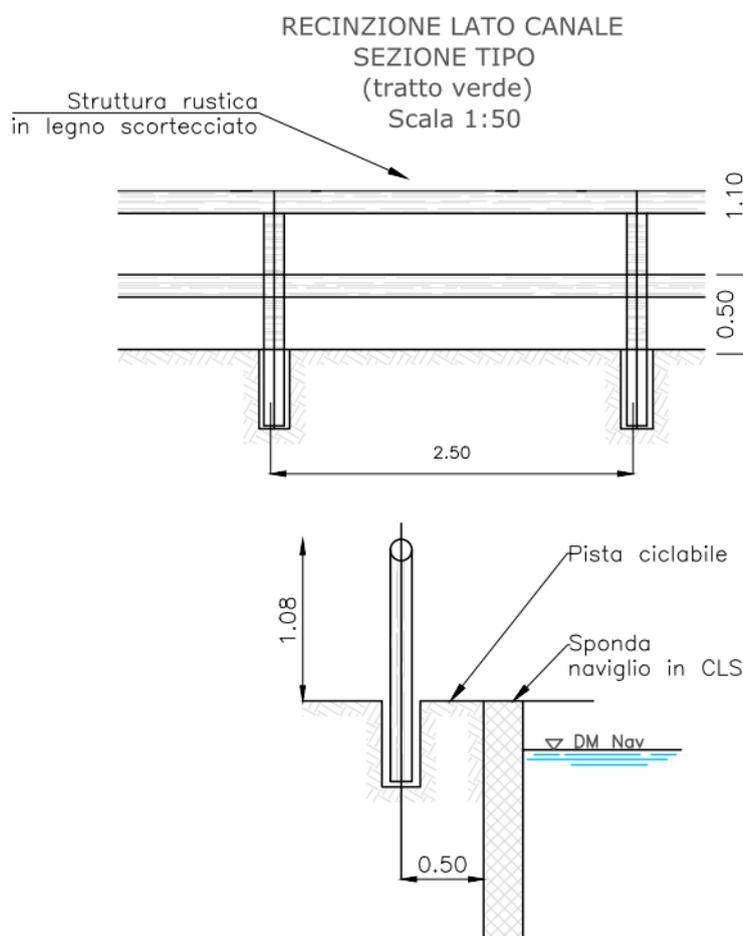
INTERVENTO DI SISTEMAZIONE E MESSA IN SICUREZZA STRADA ALZAIA SUL NAVIGLIO - DETTAGLI
